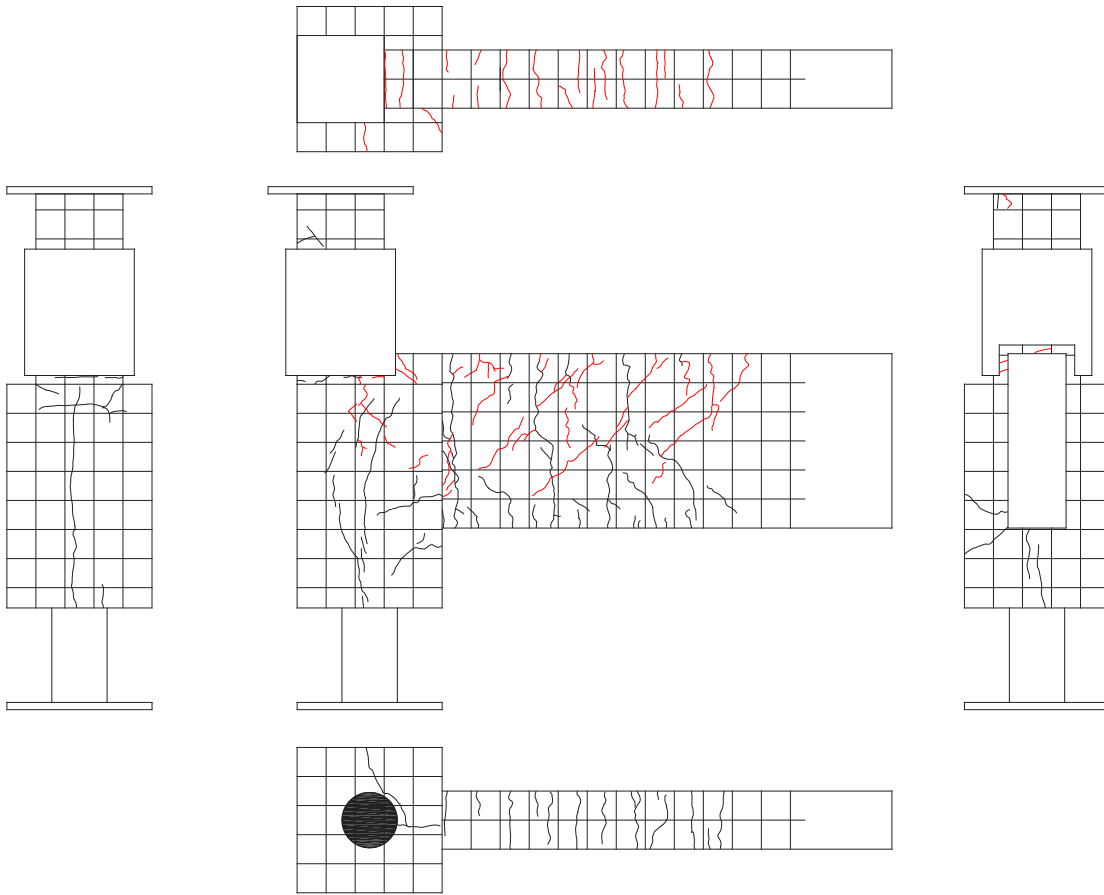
3. 95 試験体 C-2 ひび割れ状況 (4Cycle)
